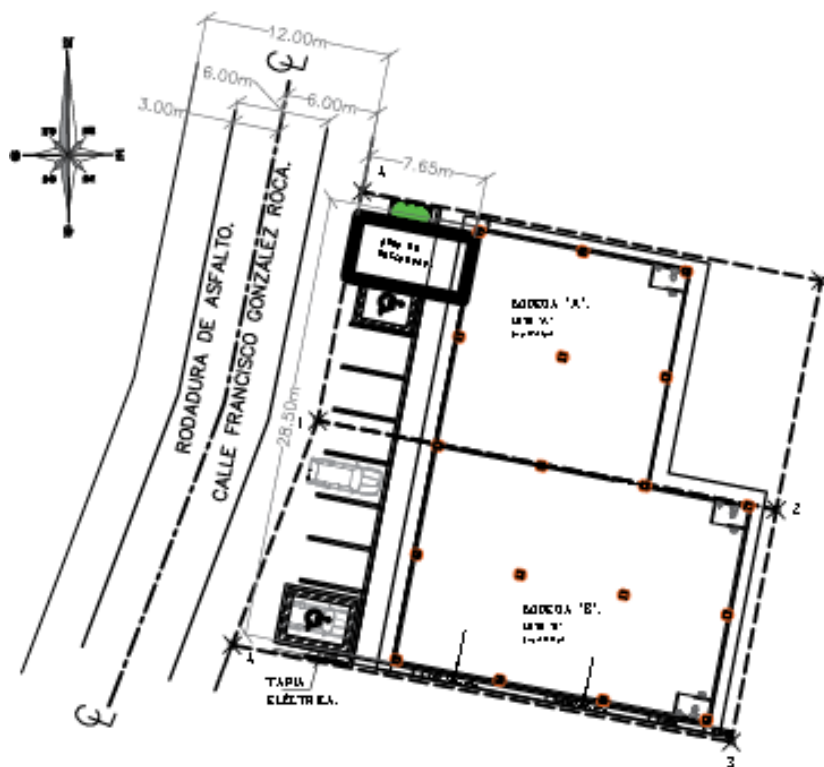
Croquis de la infraestructura a desarrollar (vista de planta)
